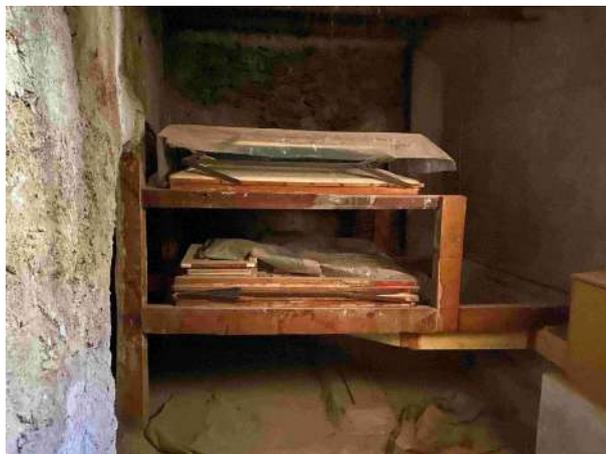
Sala 1 de la planta superior de la Casa Fundacional y conexión con la planta superior de la Casa de la Mandadera
